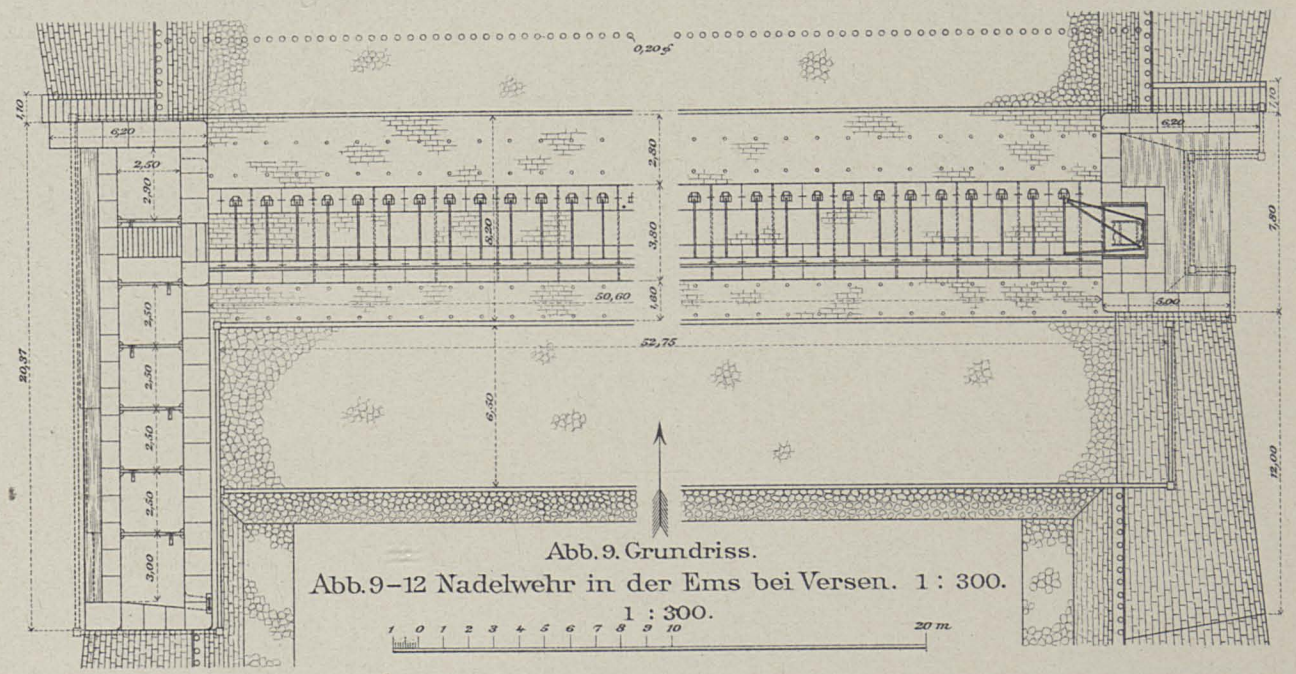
Grundriss. Abb. 9-12 Nadelwehr in der Ems bei Versen. 1 : 300.
